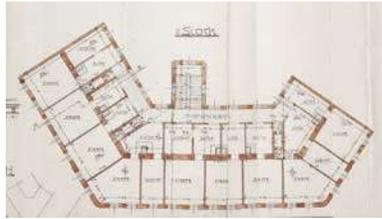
Grundriss Gründerzeit, Wohngeschoss
